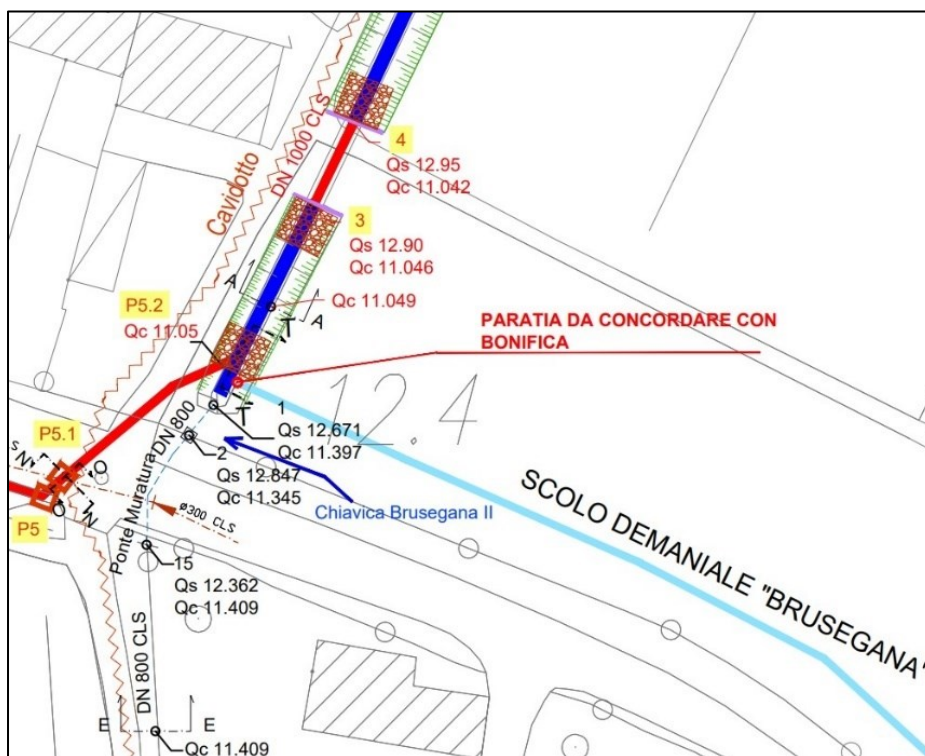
Planimetria 1 del fosso Duca degli Abruzzi
